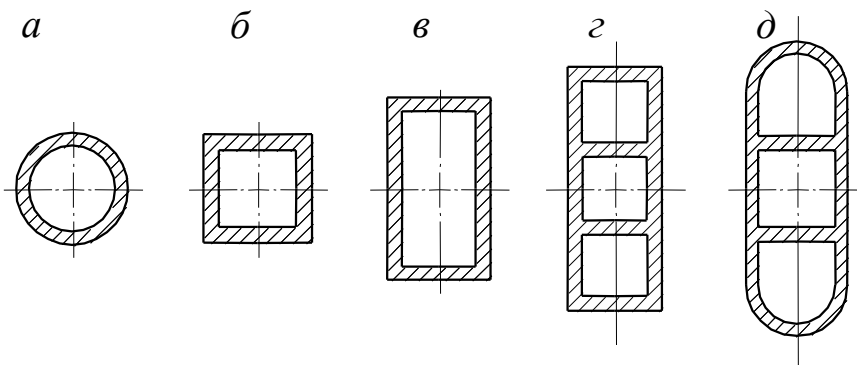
Форми перерізів опускних колодязів у плані:
